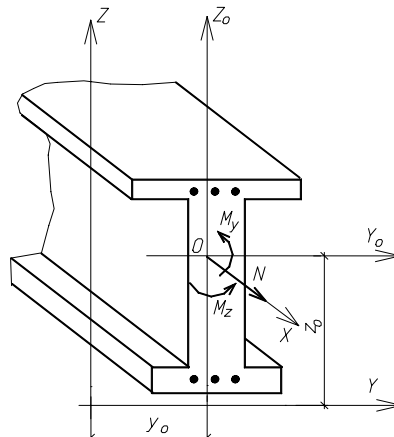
Поперечное сечение стержневого железобетонного элемента и действующие внутренние силы
